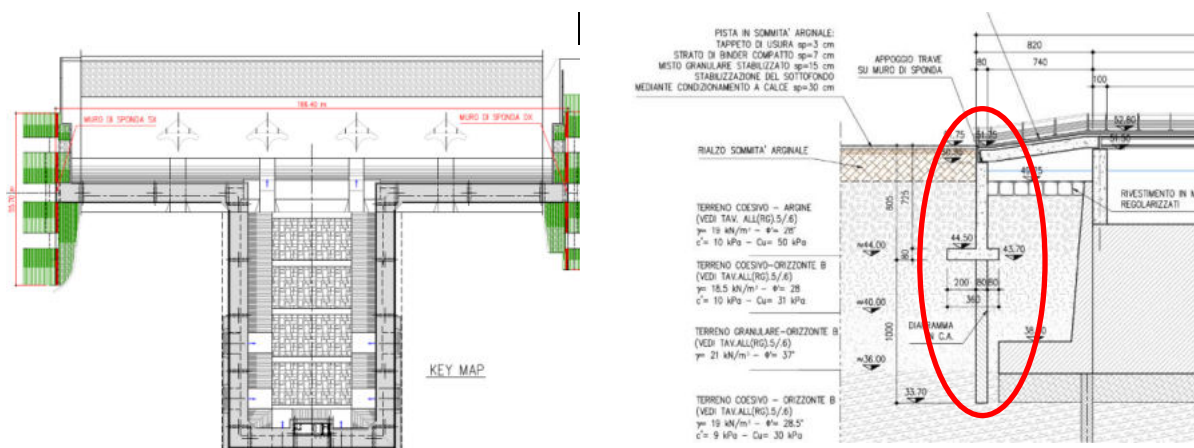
Planimetria e sezione dell'intervento sullo sbarramento esistente con indicazione dei muri di sponda
